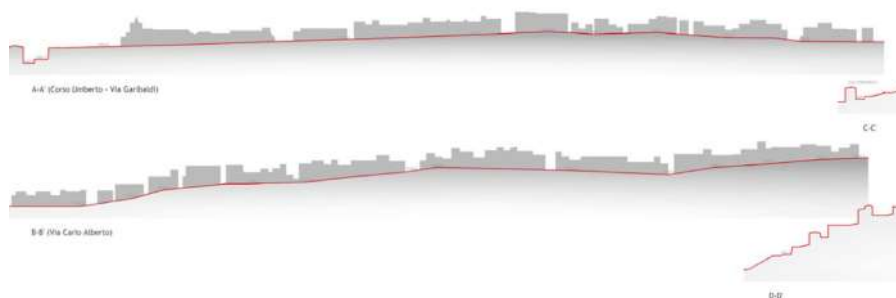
Profili stradali. (Immagine elaborata dall'Arch. Pietro Di Bella.)
